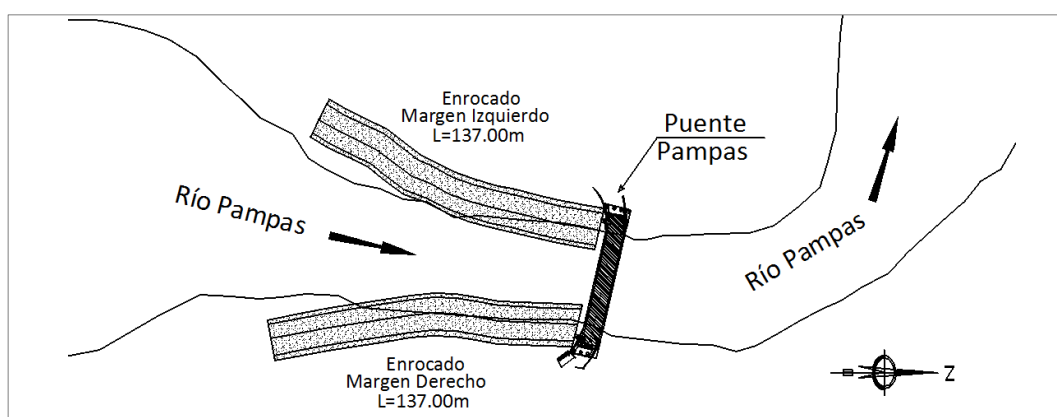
Vista en planta del puente Pampas y ubicación de enrocado de protección sobre el río Pampas.
